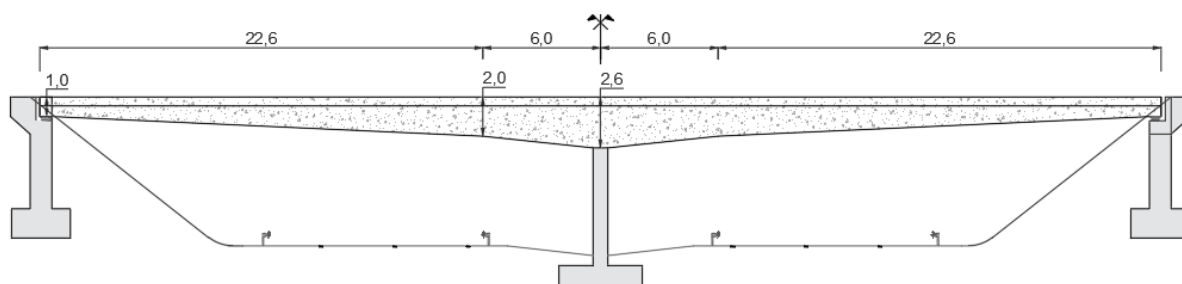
Alçado das vigas do tabuleiro em betão armado pré-esforçado
